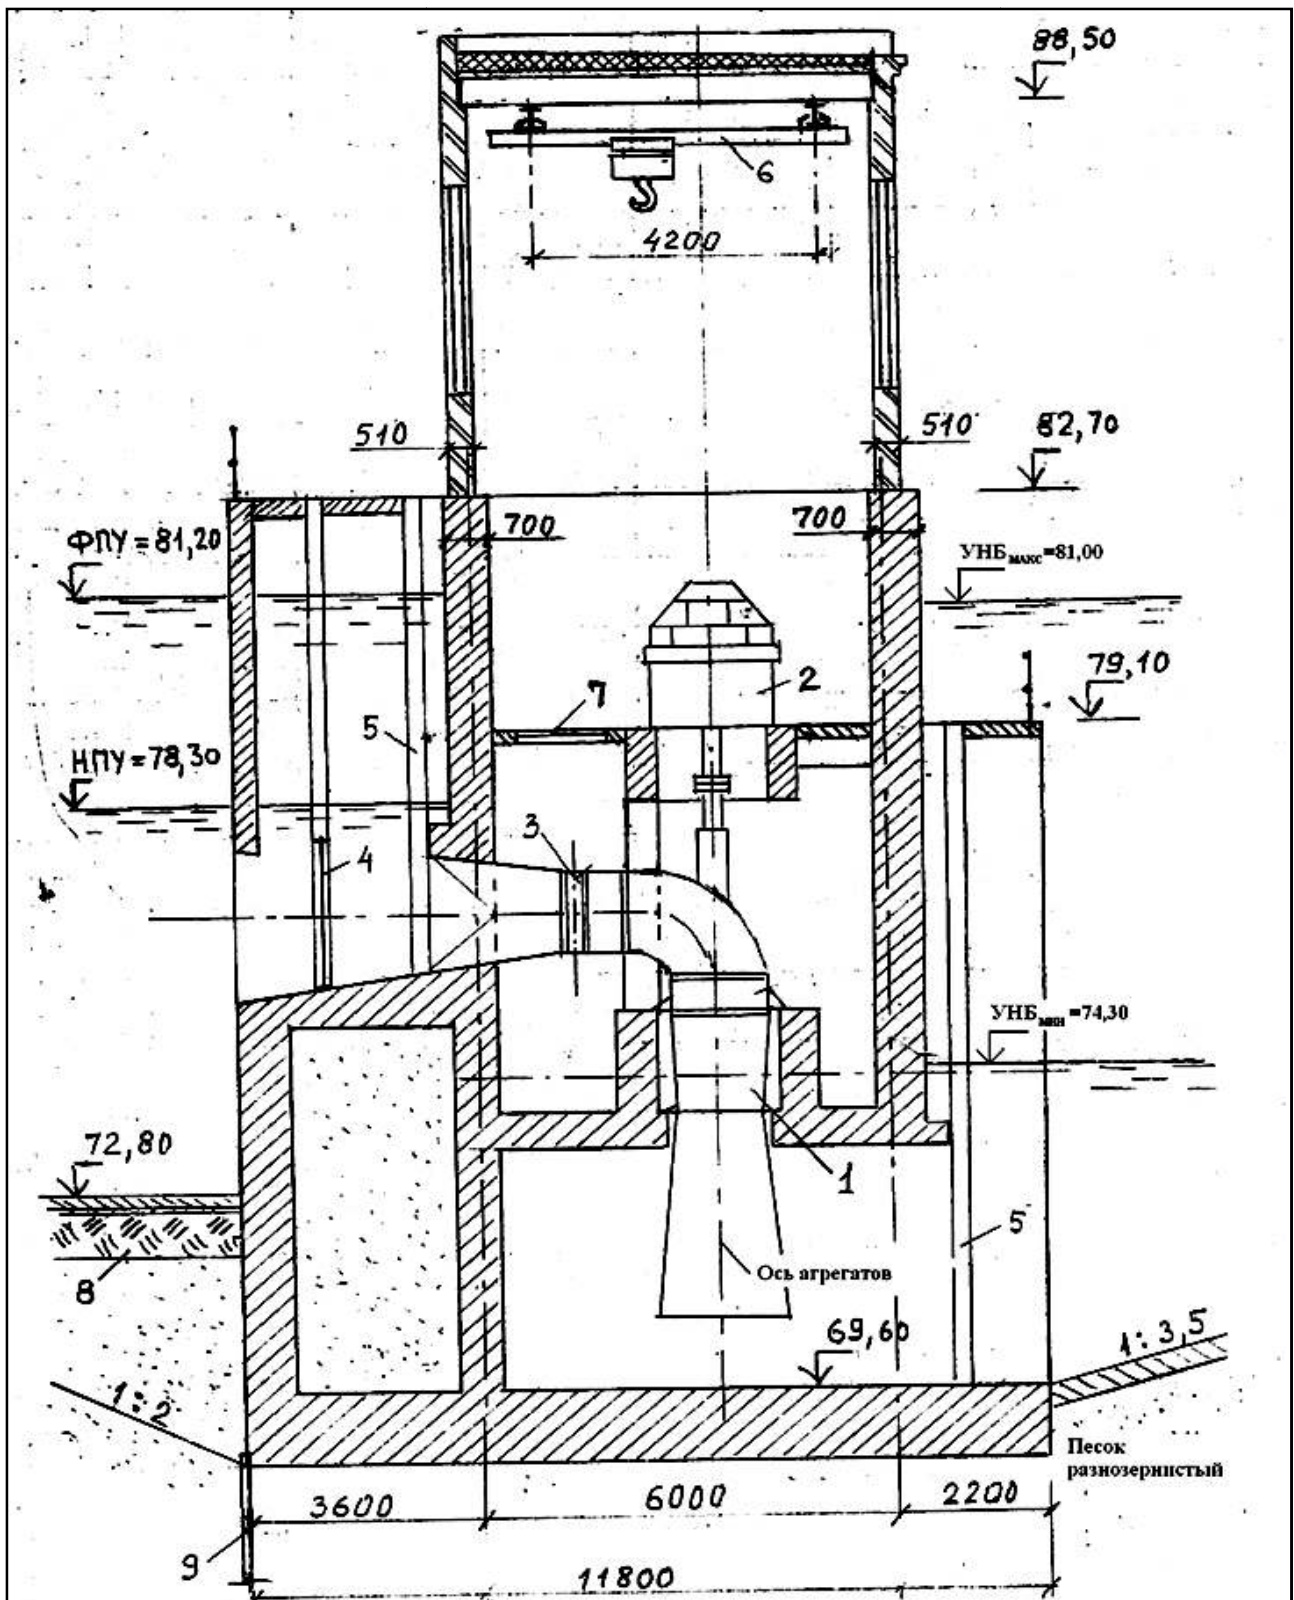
Закрытое русловое здание ГЭС с насосными агрегатами:
